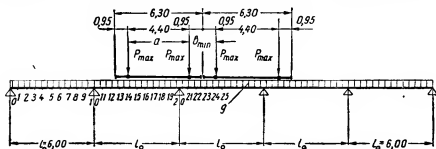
Расчетная схема балки и схема вертикальных нагрузок.
